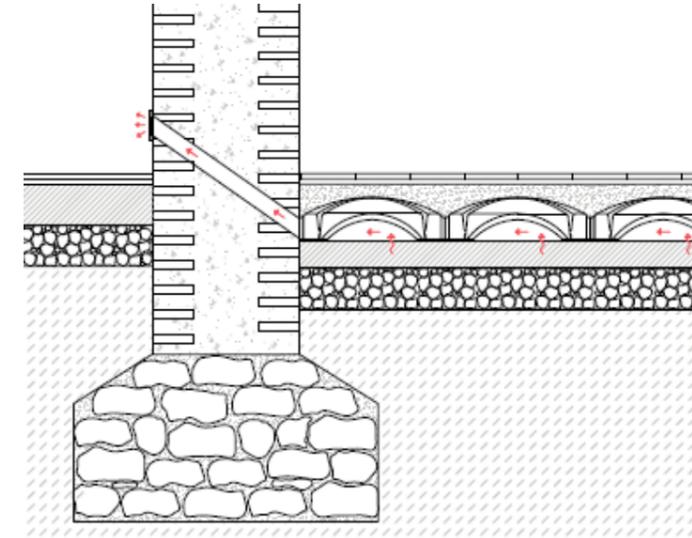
Detalle solera CAVITI (Trabajo conjunto con Paula Ferri)
